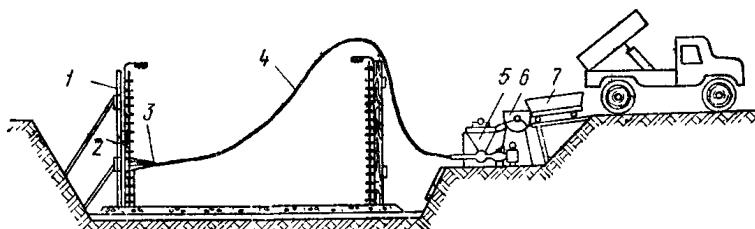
Схема организации работ по бетонированию тонкостенных конструкций резервуаров из монолитного бетона
